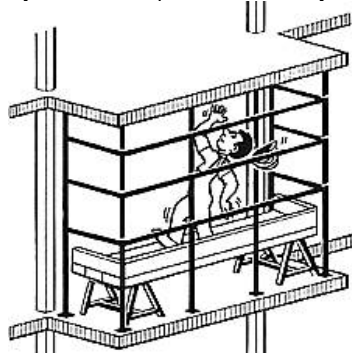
Cerramiento perimetral por medio de elementos verticales y horizontales
